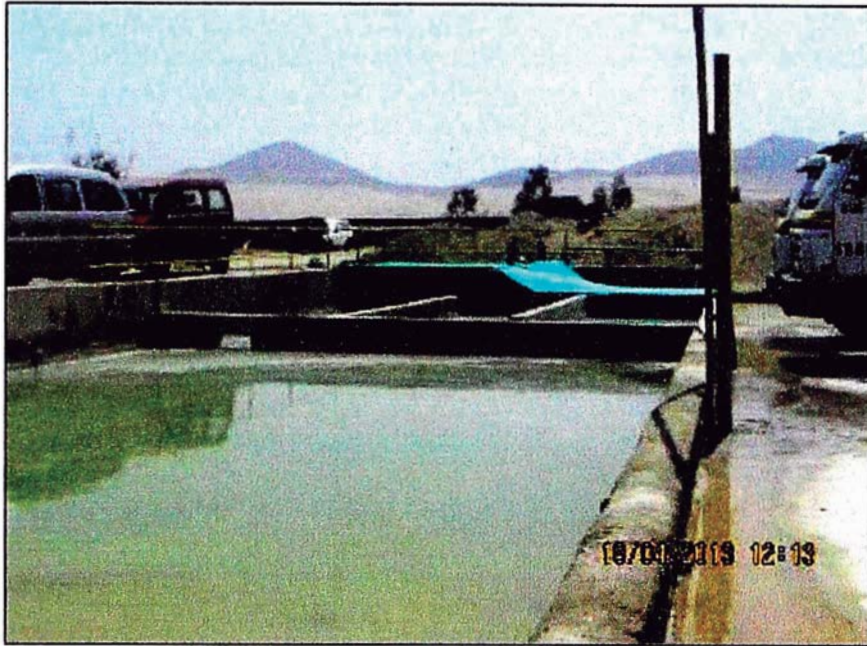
Diseño del sistema de pozas de tratamiento de lavado planta N° 1
